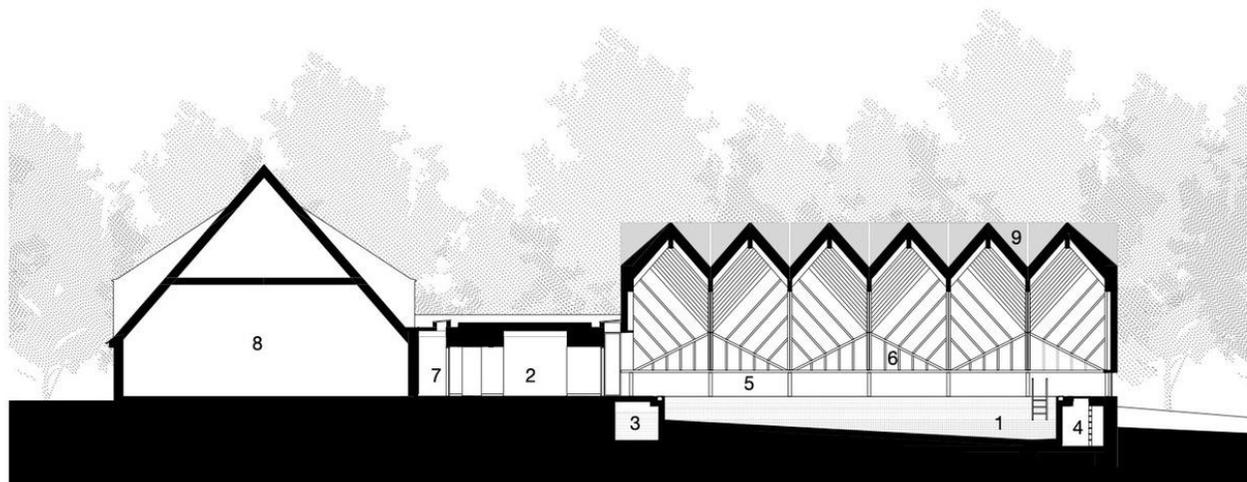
planta arquitectónica (Archdaily, 2019).
